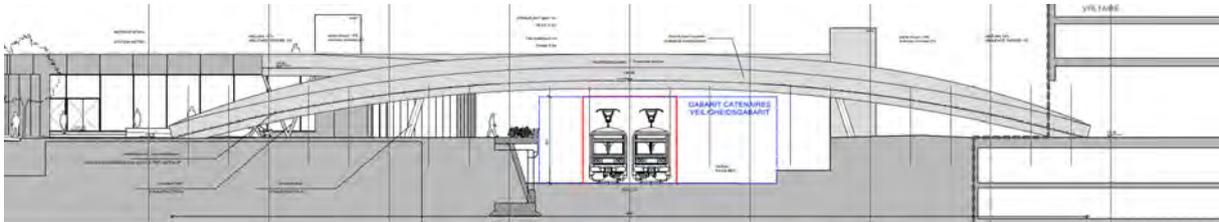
Coupe longitudinale de la passerelle (BMN, 2018)
